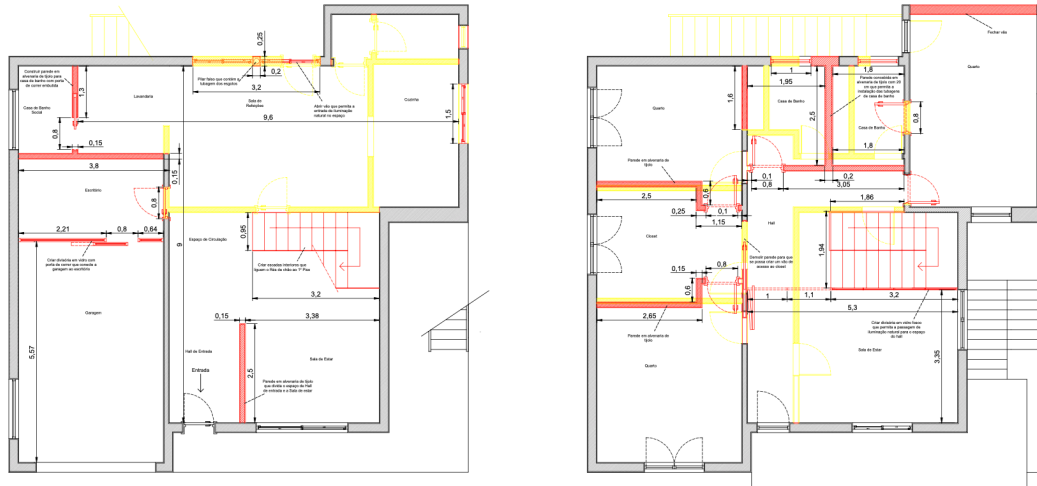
Planta de alterações - Rés de Chão e Piso 1
